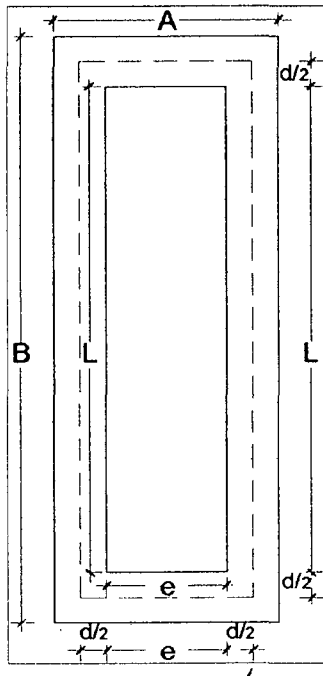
Esquema en planta de acción de la fuerza por punzonamiento.
